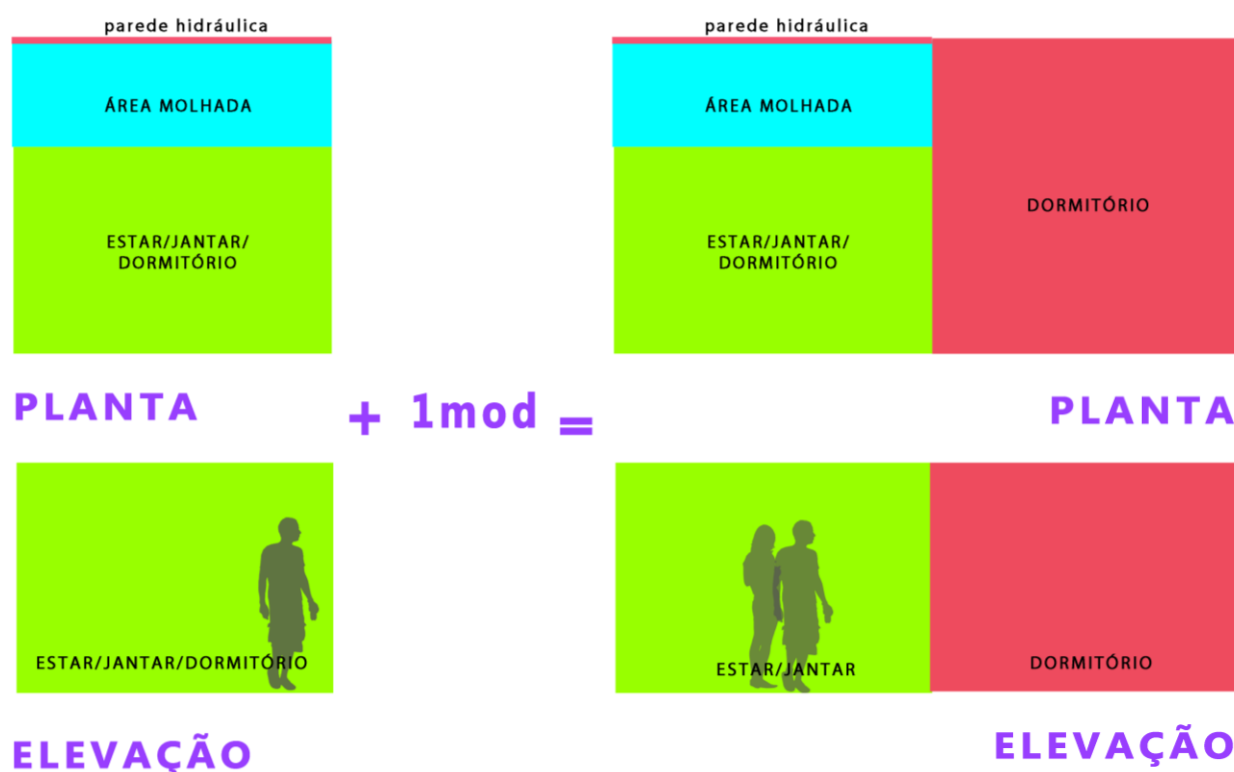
Setorização e modulação da unidade emergencial térrea
